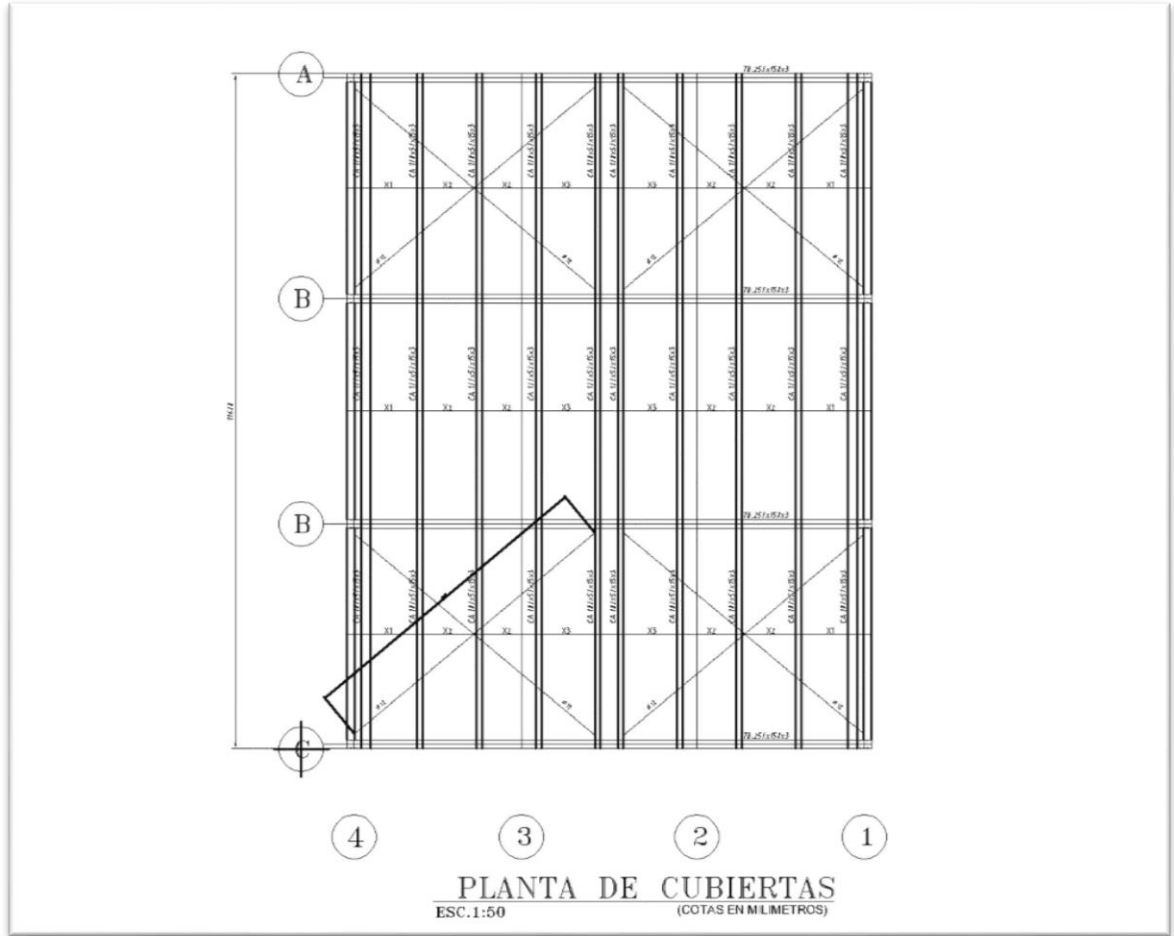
4: Planta elevaciones je 1-4 nave 12x9 para almacenamiento de materiales
